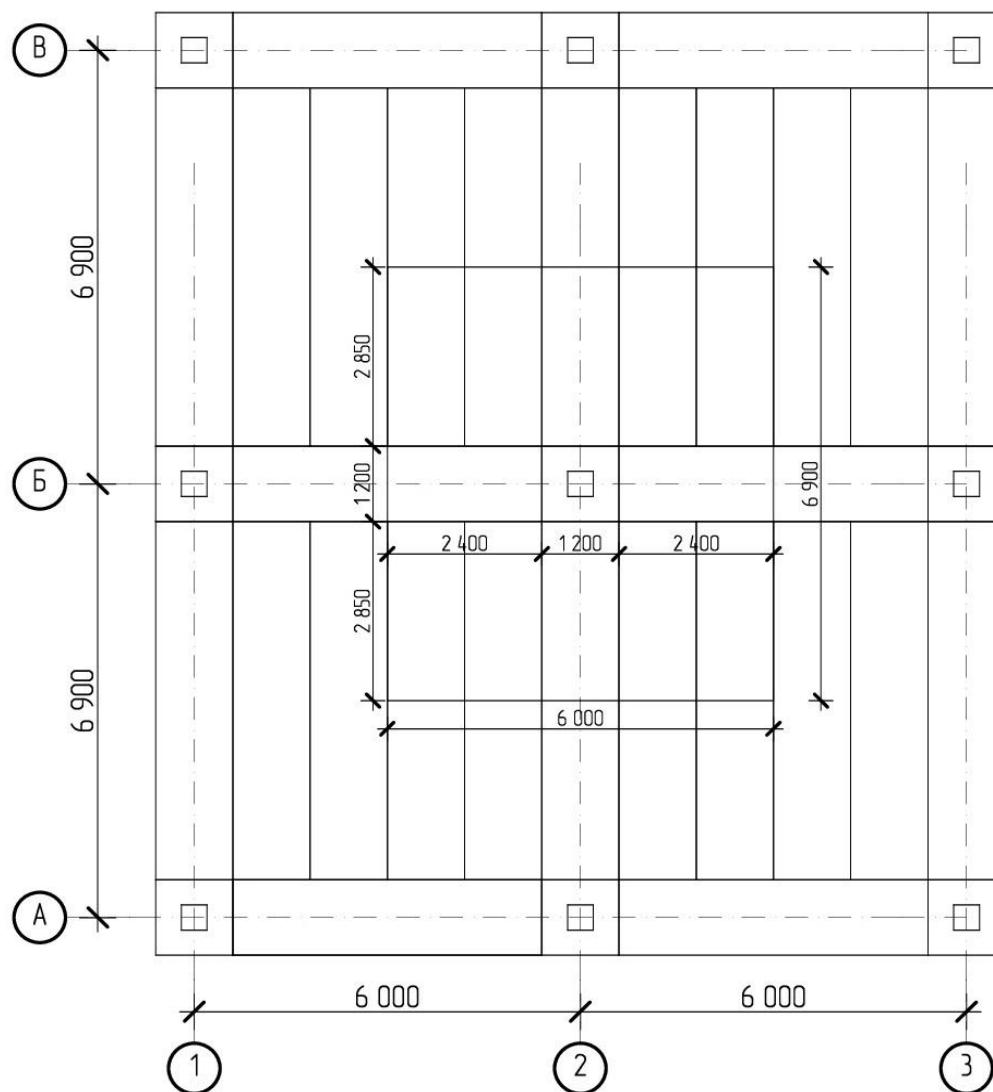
Збір навантаження на надколонну плиту середнього ряду (ПНК)
